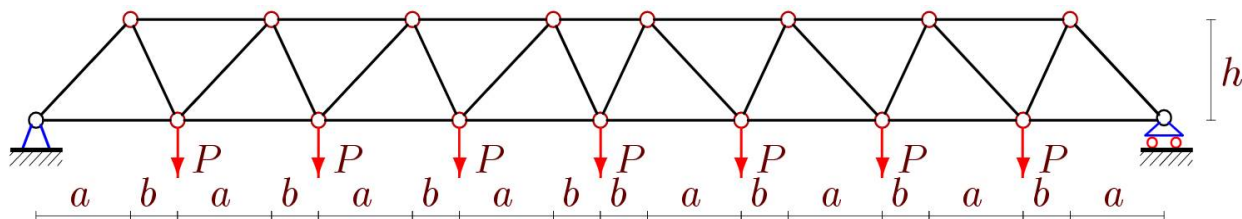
Нагрузка на нижний пояс фермы, $n = 4$
